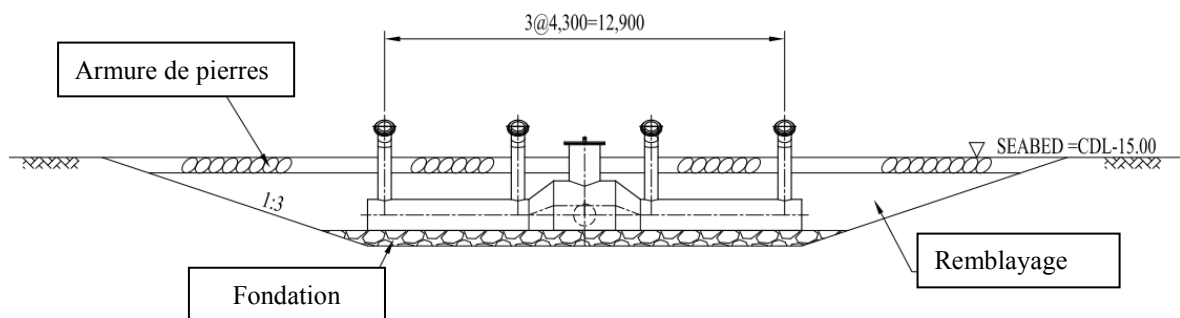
Coupe Longitudinale de la Conduite de rejet des saumures
